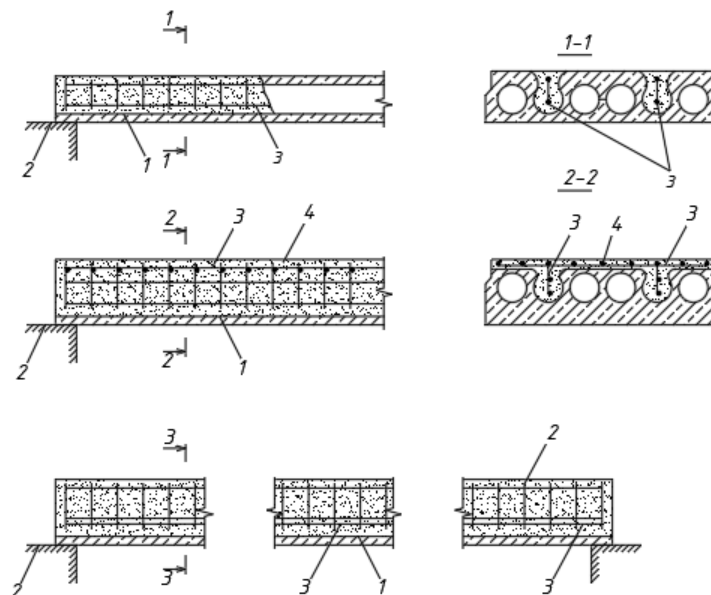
Підсилення збірних багатопустотних плит перекриття.
